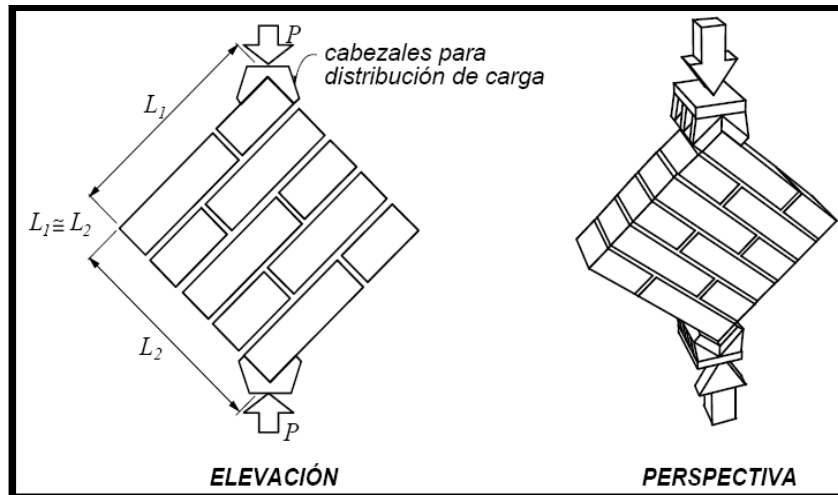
Murete para prueba a compresión diagonal (APROYNMX-C-000-ONNCCE-2010).
